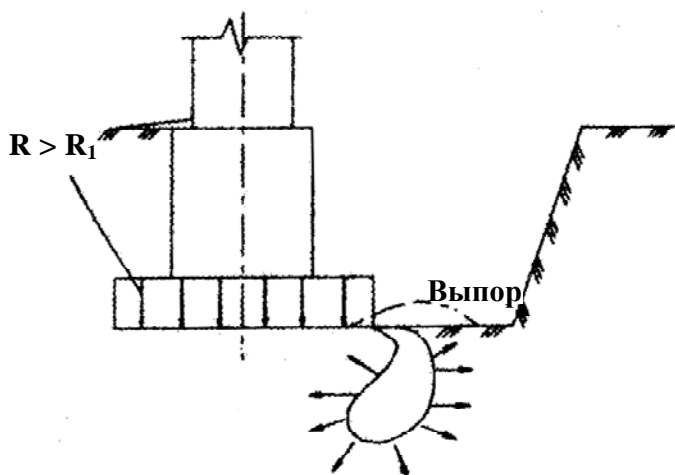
Возможный выпор грунта при откопке траншеи до подошвы существующего фундамента (при усилении с использованием традиционных технологий)
